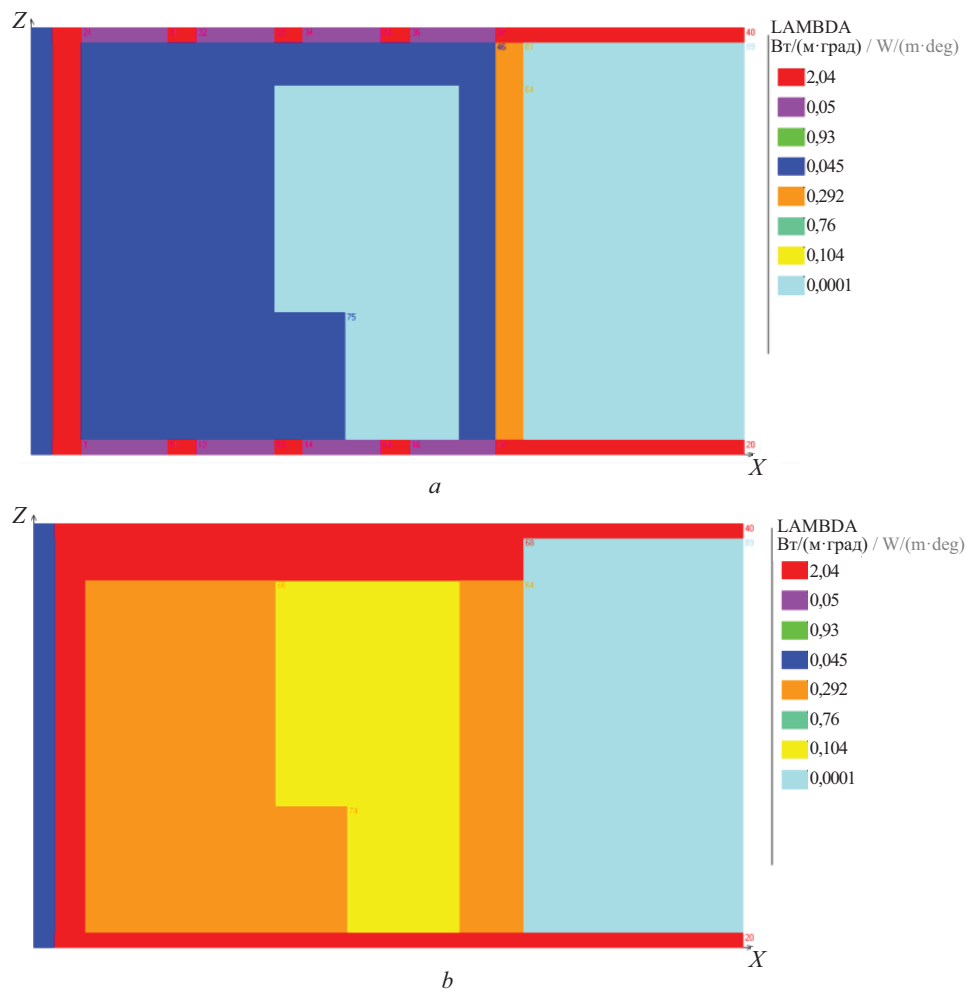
Расчетная схема. Вид на наружную грань продольной стены лоджии: *a* — по утеплителю; *b* — под утеплителем
